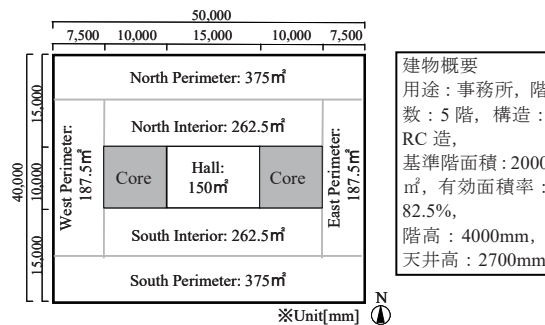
基準階平面図および建物概要 (Typical Floor Plan and Building Outline)
